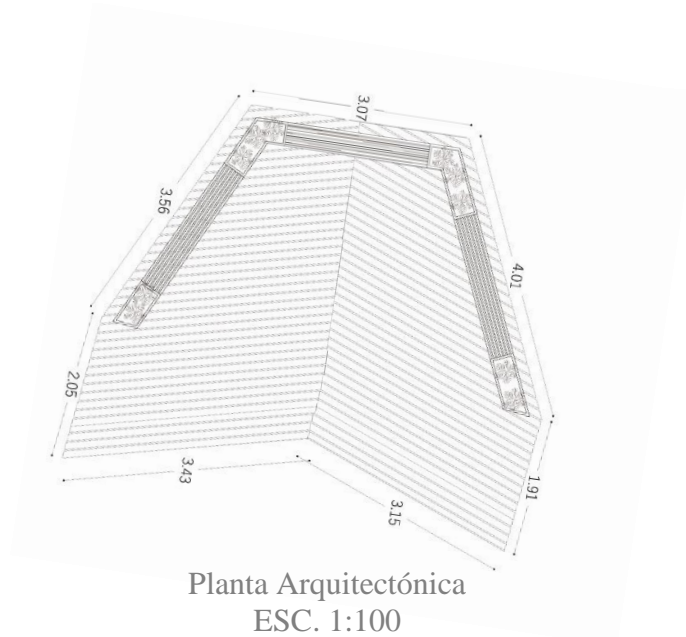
Planta arquitectónica de estancia 3. Fuente: grupo de investigación.
